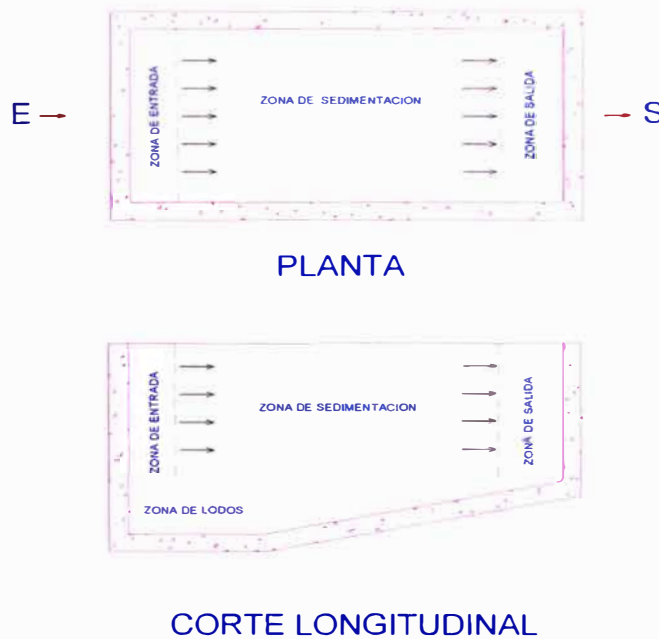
COMPONENTES DE UNIDAD TIPO DECANTADOR ESTATICO
